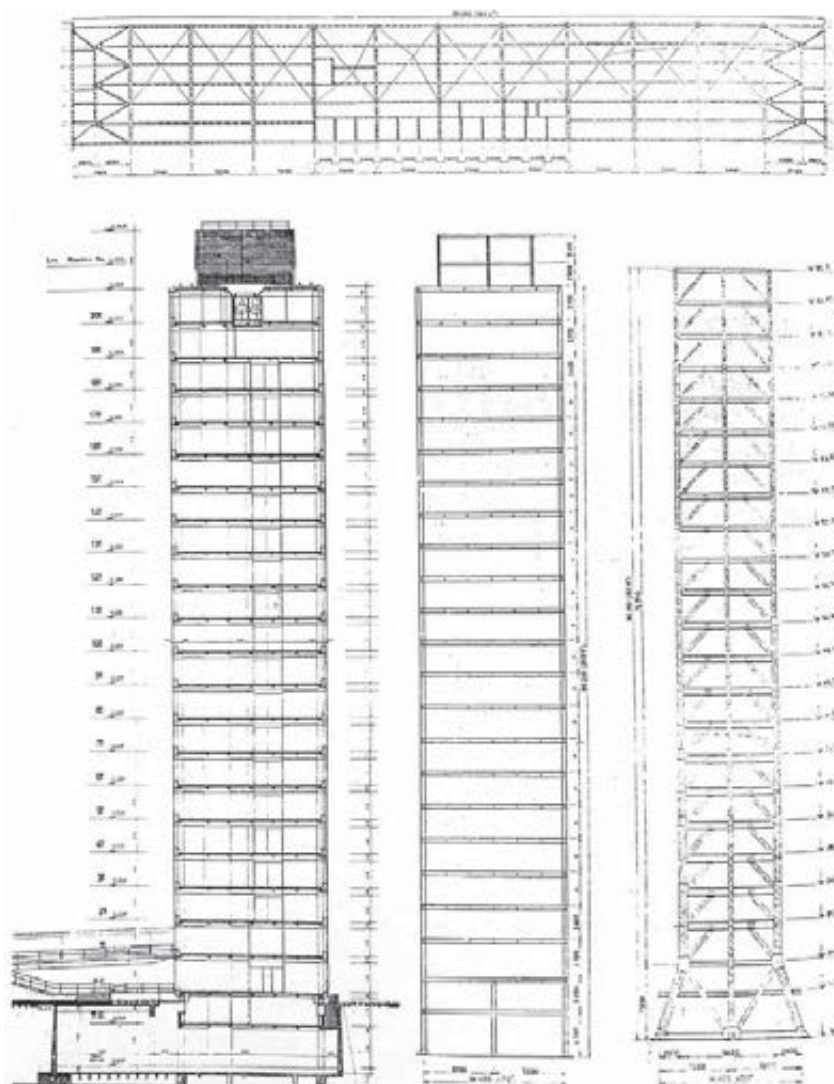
Pianta della struttura di acciaio del piano tipo, sezioni trasversali e pareti di controvento (da Acciaio, n. 1, 1962)
